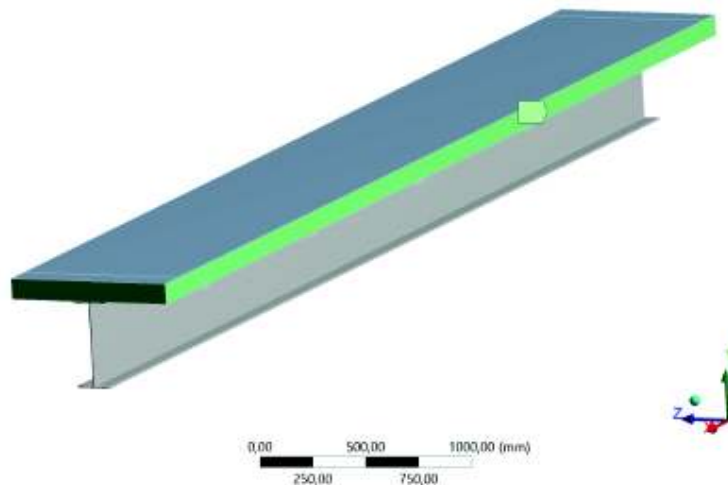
Restricción de los desplazamientos en las caras de la viga metálica VT1
